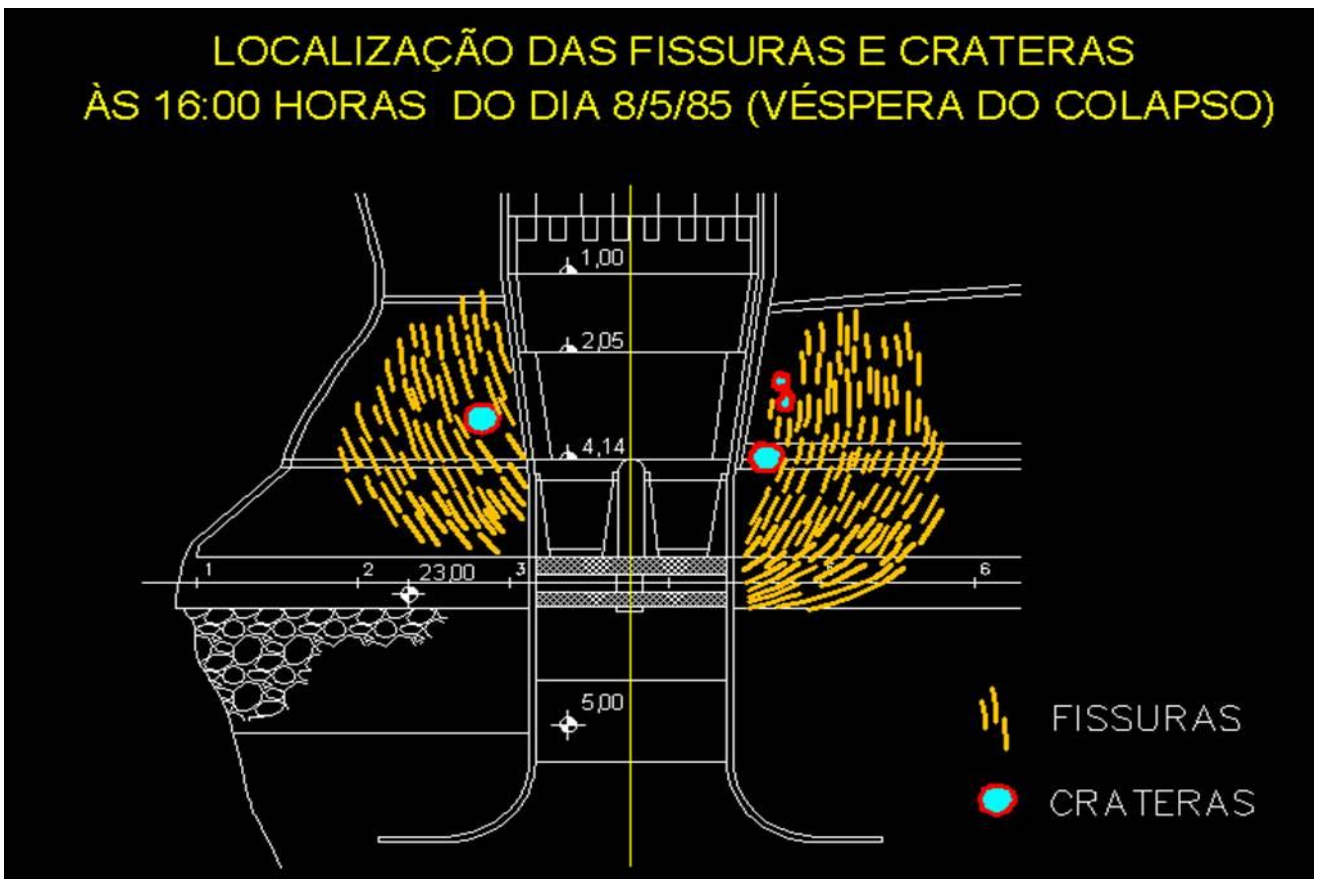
Fissuras e crateras, Fonte: Erton, 1999.
